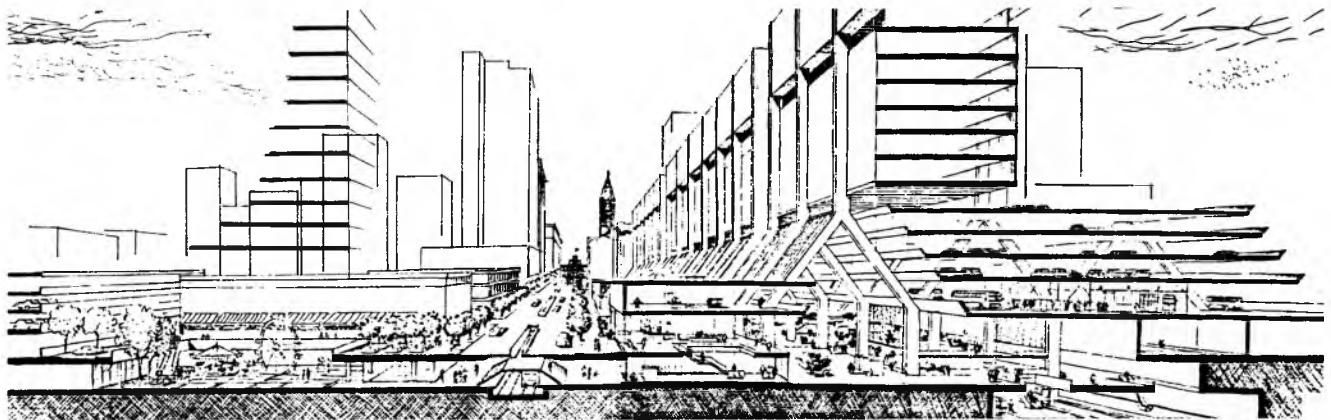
Plan središta Philadelphije sa središnjom avenijom Market Street
